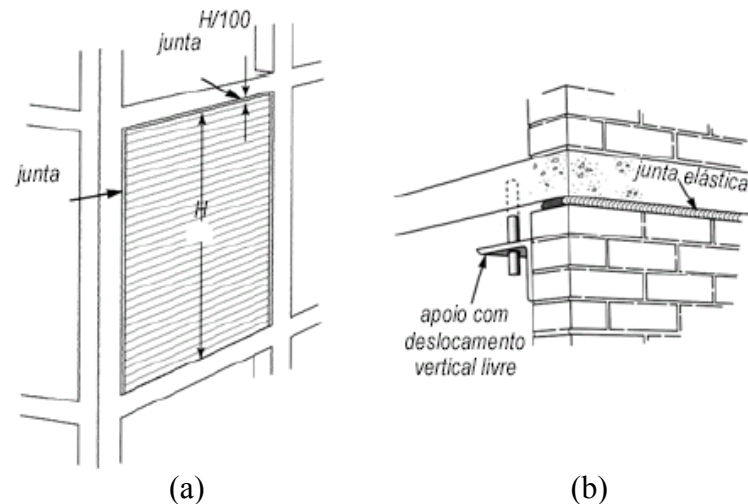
Exemplos de dispositivos de desvinculação entre as paredes e a estrutura: (a) sistema flexível (juntas elásticas no topo e nas laterais entre a parede e os elementos estruturais, há apenas uma ligação rígida (na base)); (b) junta elástica entre a alvenaria e a face inferior da laje (SILVA, 2002).
